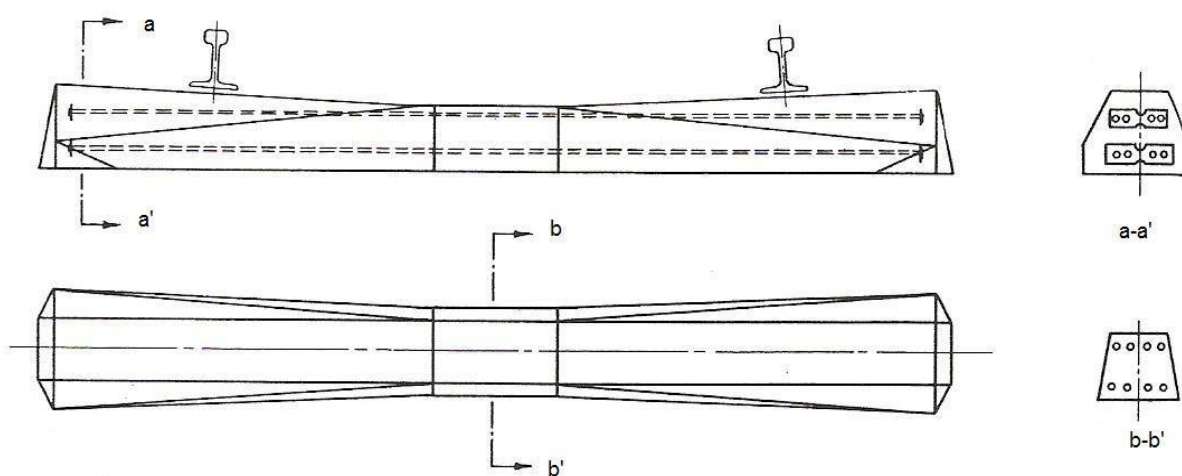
Dormente em concreto protendido, modelo DYWIDAG (Alemanha)
